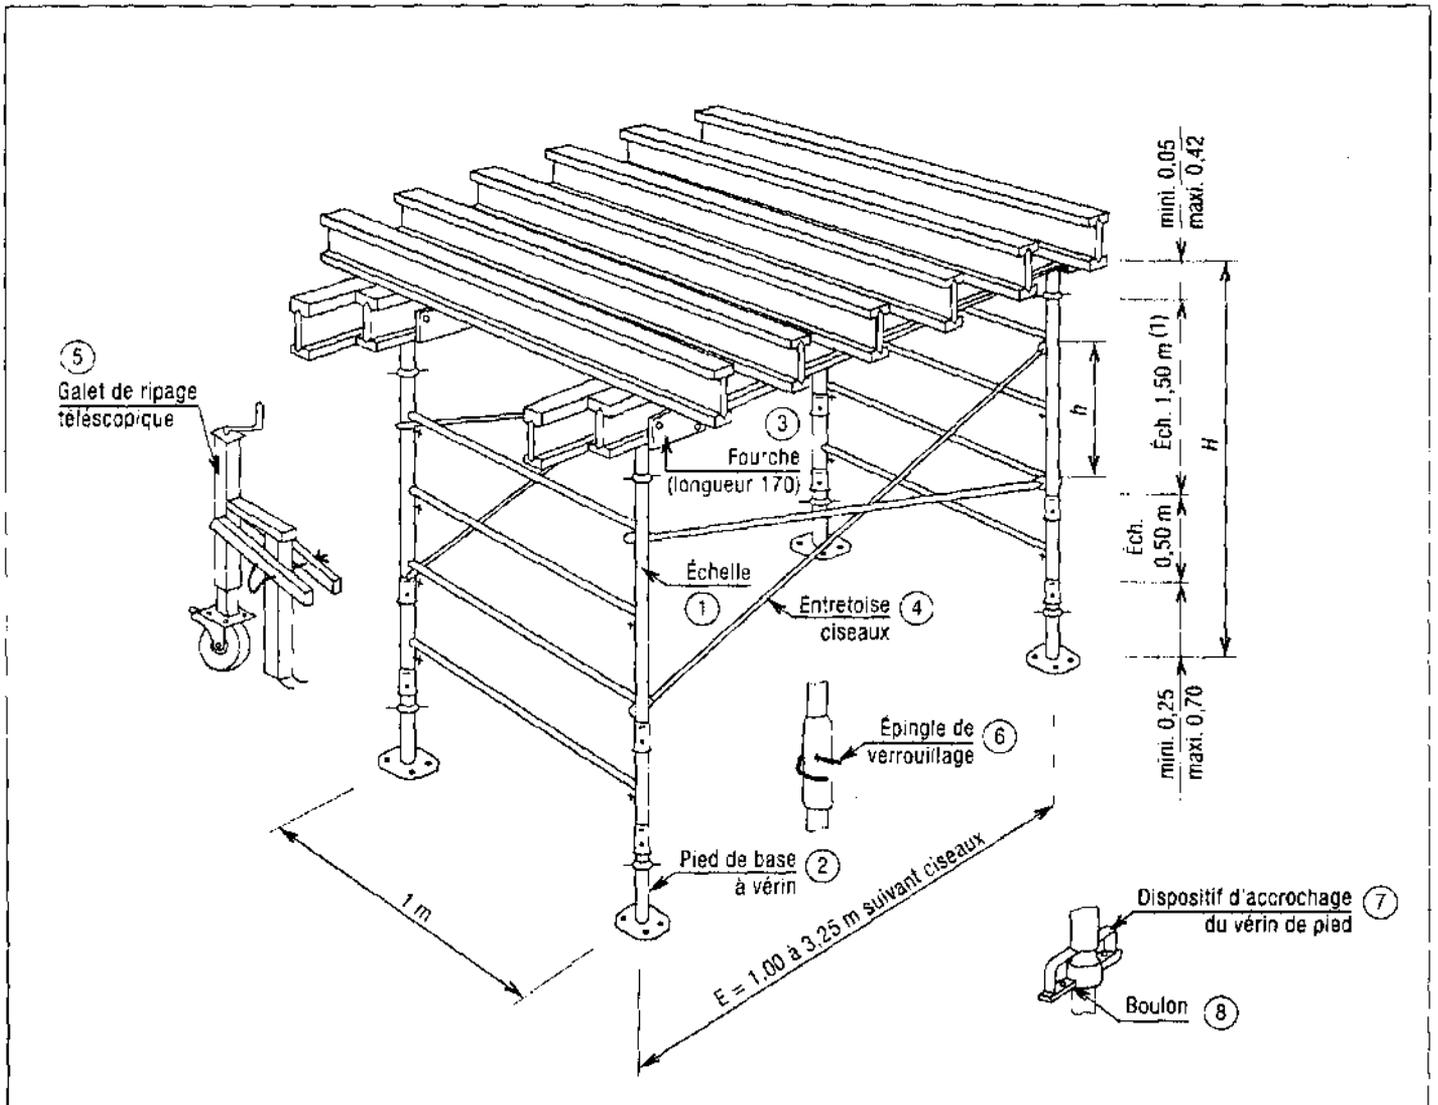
Appui des poutrelles primaires H20 ($l = 3,90$ m).
